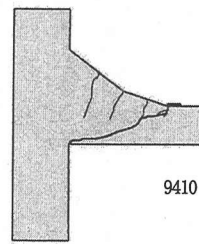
TYPE-III②試験体のひび割れ発生状況
